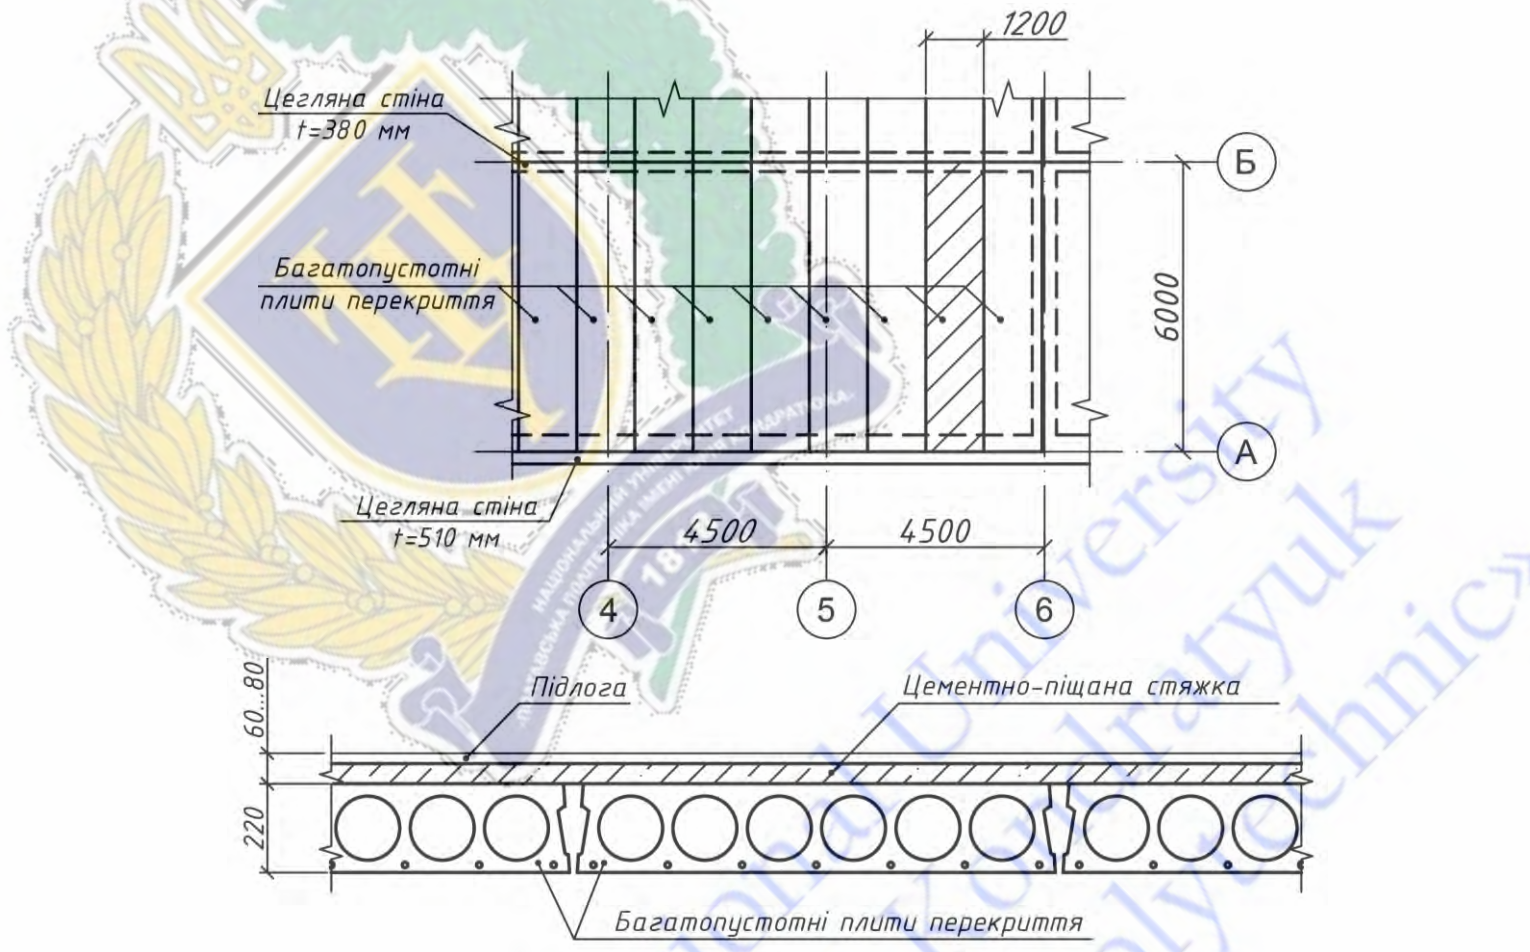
Загальний вигляд ділянки будівлі, на якій необхідно виконати проектування підсилення міжповерхового перекриття із збірних залізобетонних багатопустотних плит над підвальним приміщенням
